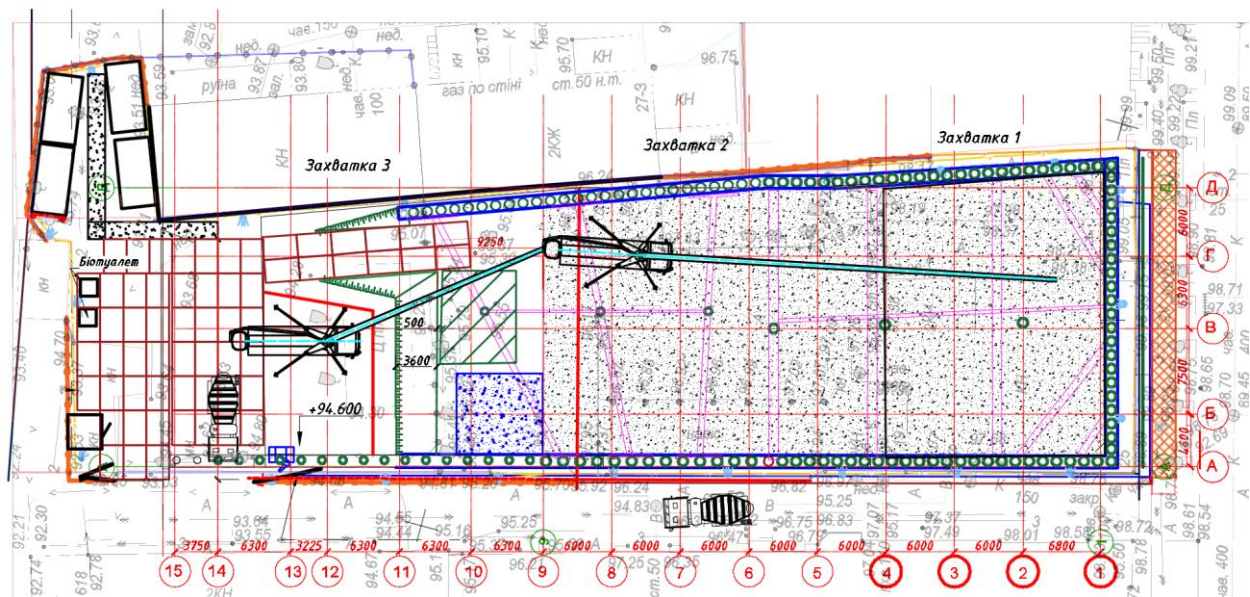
Розташування будівельної техніки на етапі бетонування фундаментної плити.
